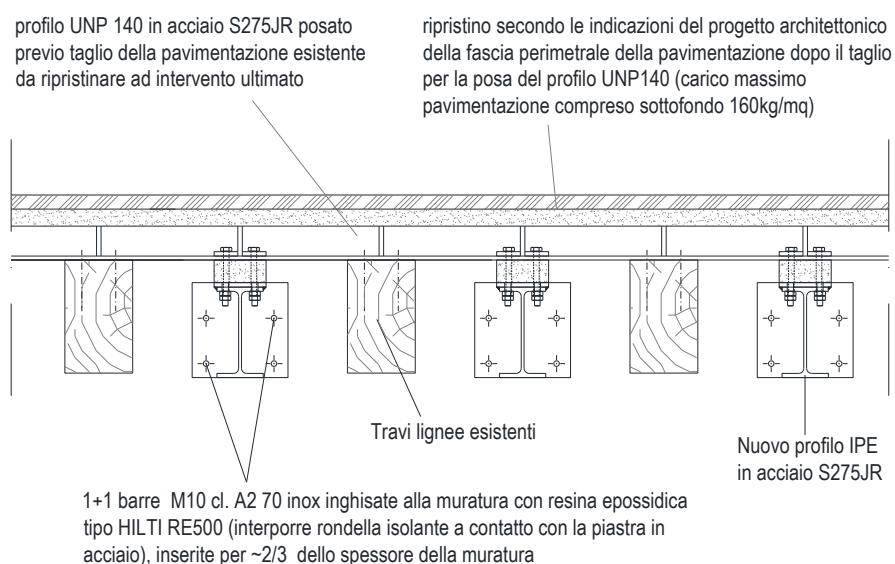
dettagli-tipo dell'intervento (sezione trasversale alla direzione delle travi)
